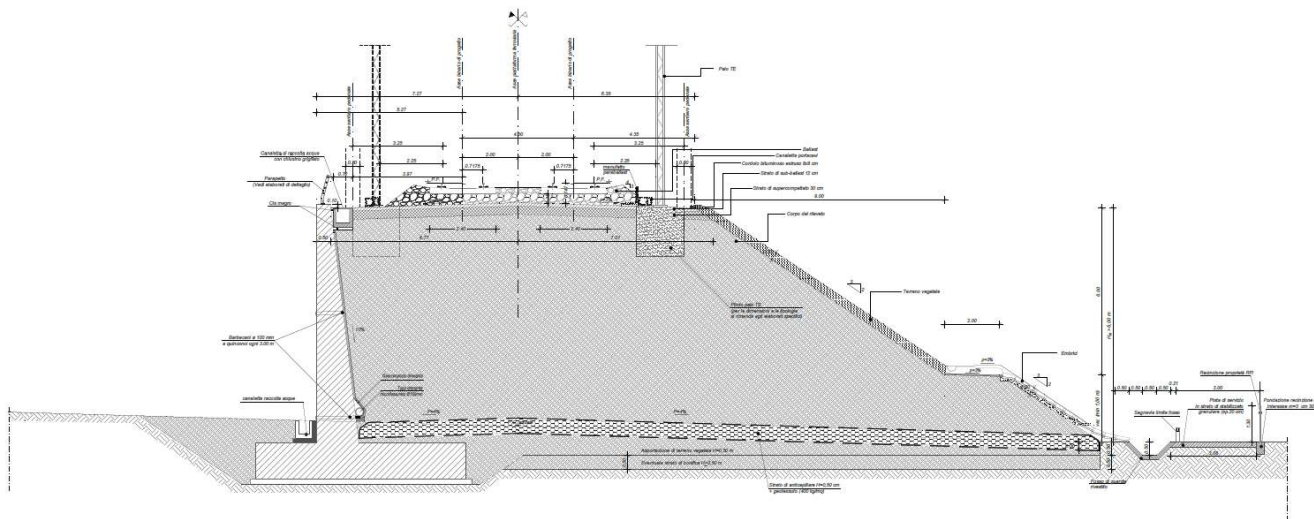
Sezione tipo ferroviaria in rilevato con muro di sottoscampa senza barriera antirumore
